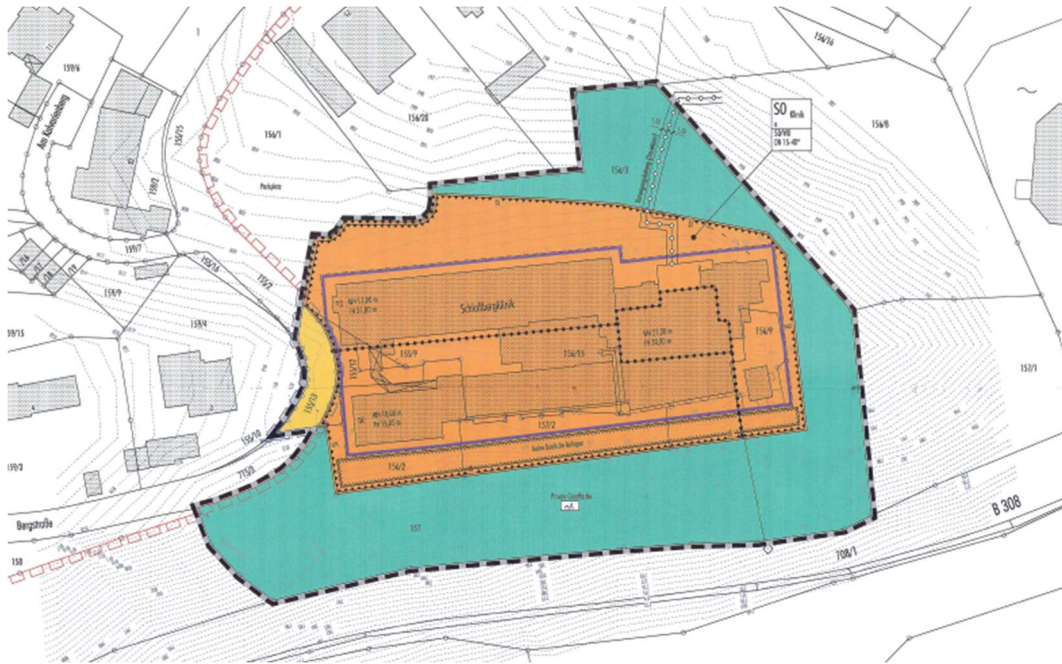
Ausschnitt Planteil 2. Änderung Bebauungsplan "Schlossbergklinik"
